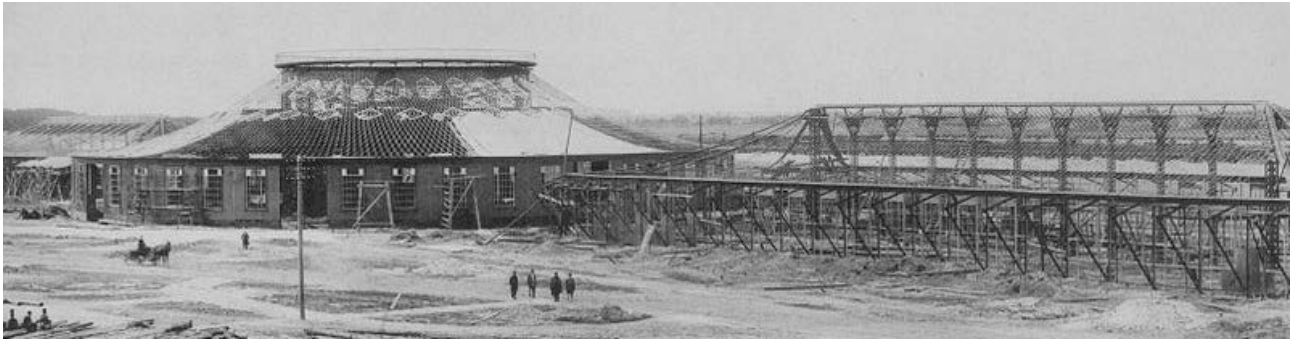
Vista de La rotonda y de La gran sala de máquinas.
